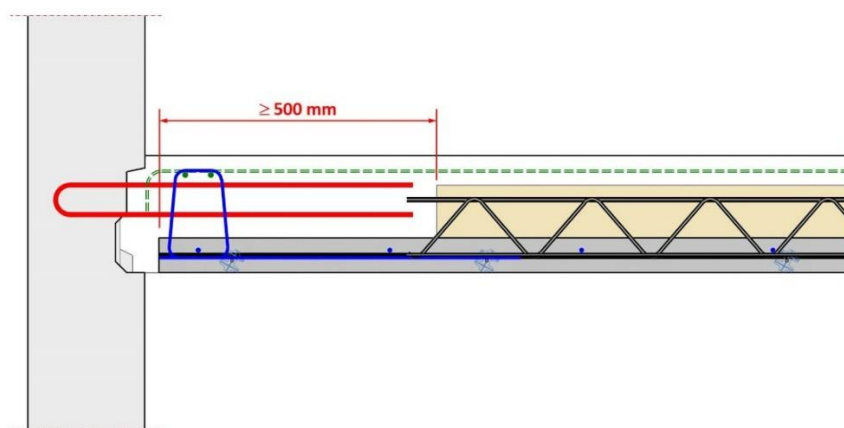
exemple LPPVE - Dalle WOODlite suspendue des 2 côtés en considérant la pose de banches intérieures en premier
